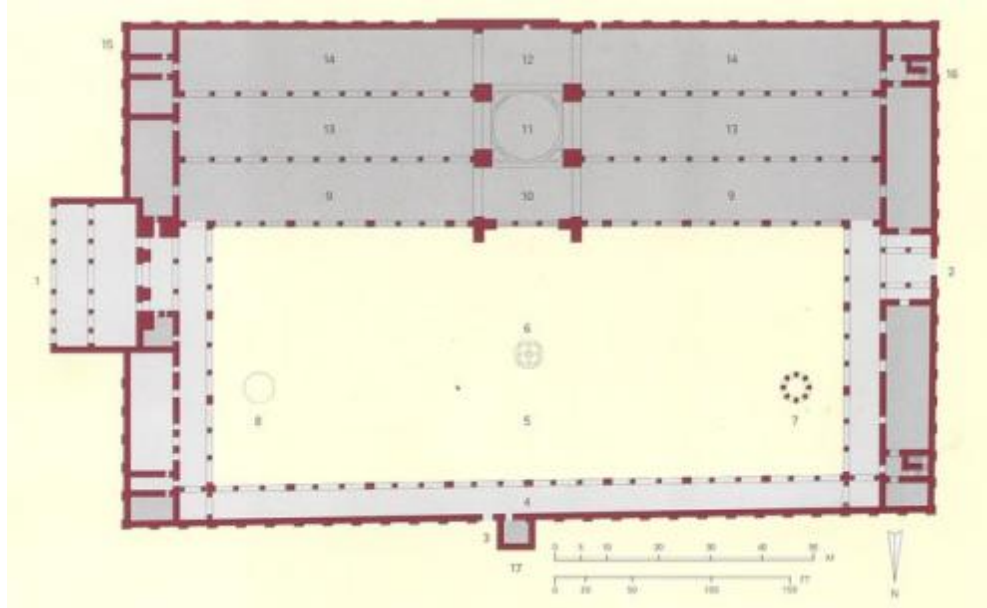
Planta Mezquita de Damasco, Damasco, Siria, siglo VII.
